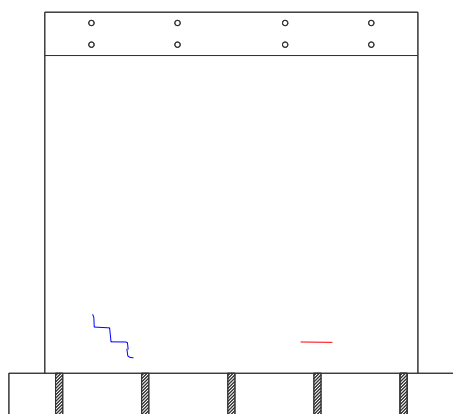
Ninguna reparación en muro de albañilería confinada con ladrillos pandereta industrial en la distorsión 1/4200.
